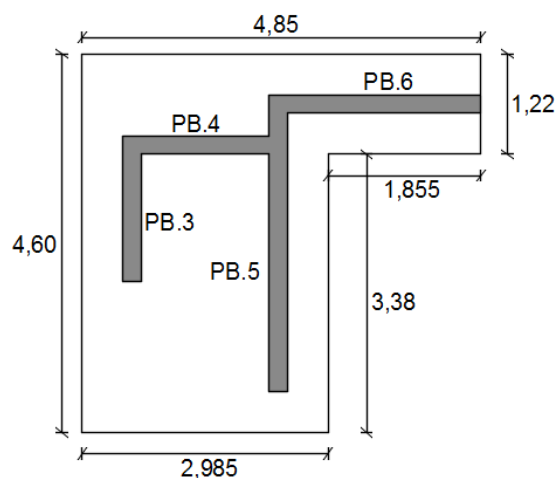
Representação em planta da sapata do núcleo de elevador e da caixa de escadas.
